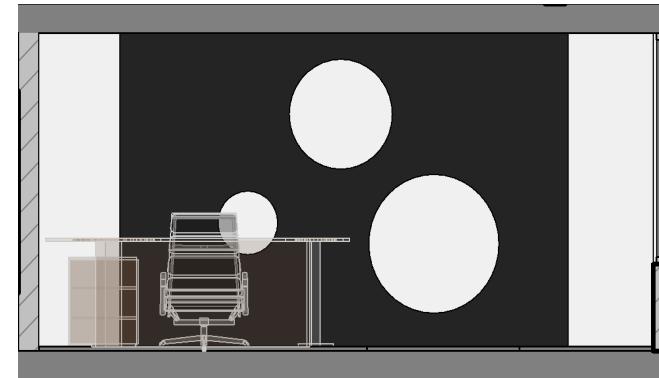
2da Plana Alta - Elevación 04 Pared con gypsum y estucado y pintado
